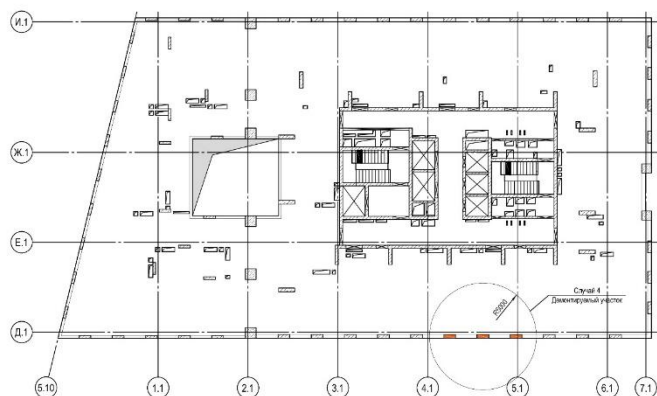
Корпус К-1. Схема аварийного случая 4
